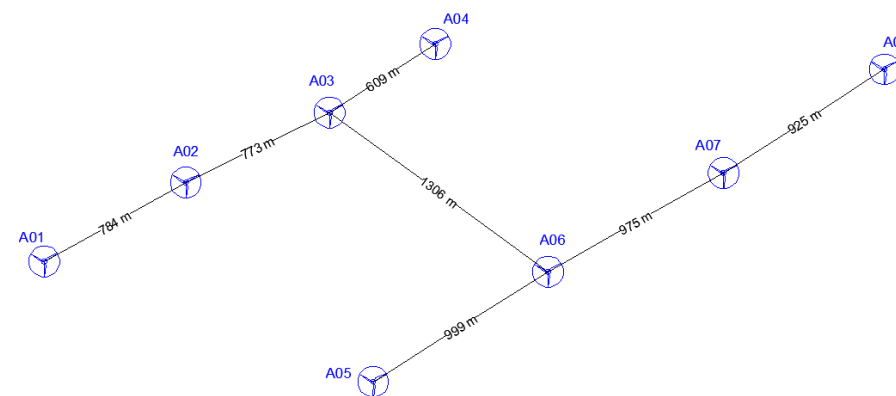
Schema layout con indicazione delle interdistanze tra le tribune di progetto
